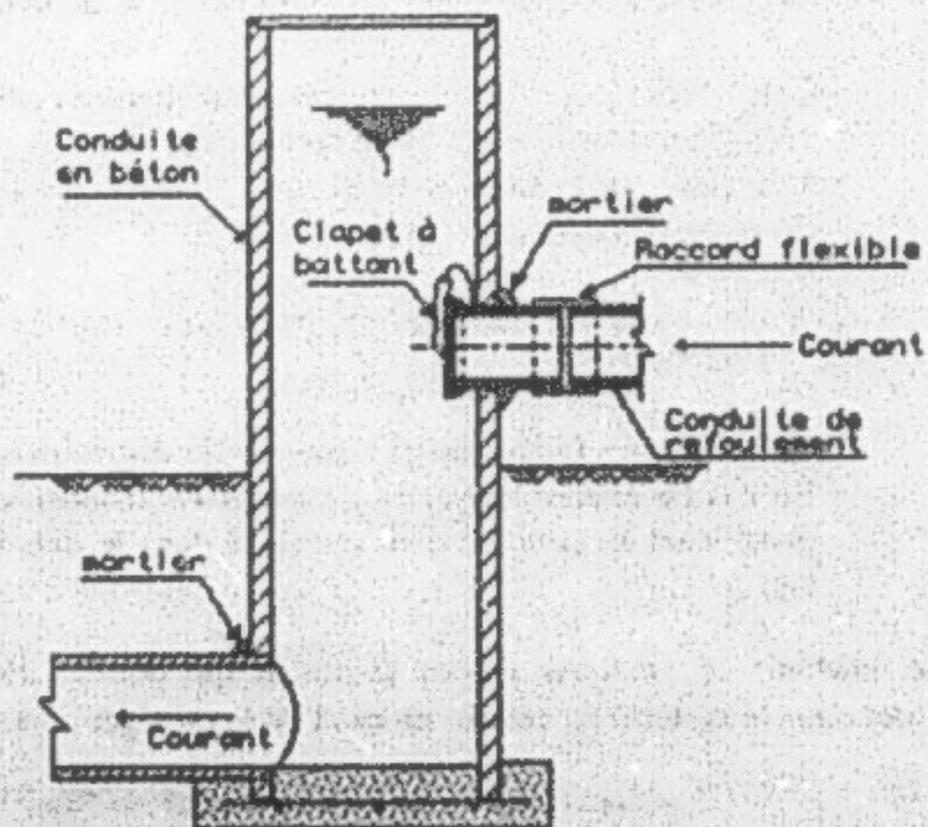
Ouvrage de raccordement à un groupe de pompage
